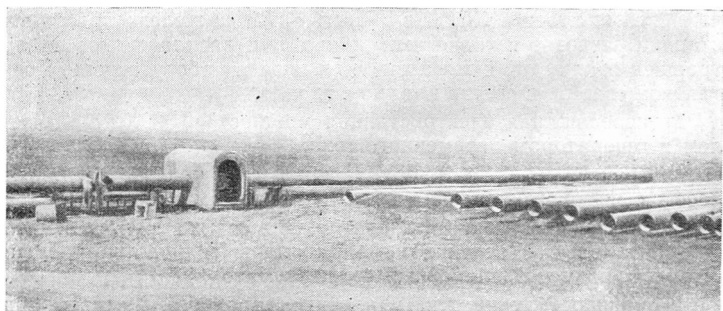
Полустационарная установка для автоматической двусторонней сварки поворотных стыков труб диаметром 720 мм.
